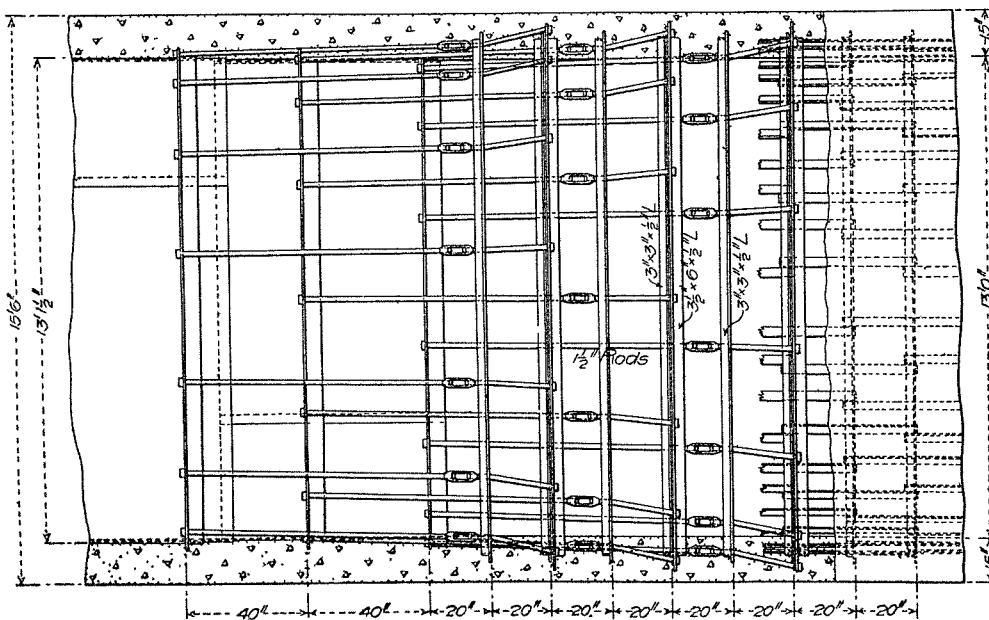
Jonction de la conduite forcée et du revêtement du tunnel.
